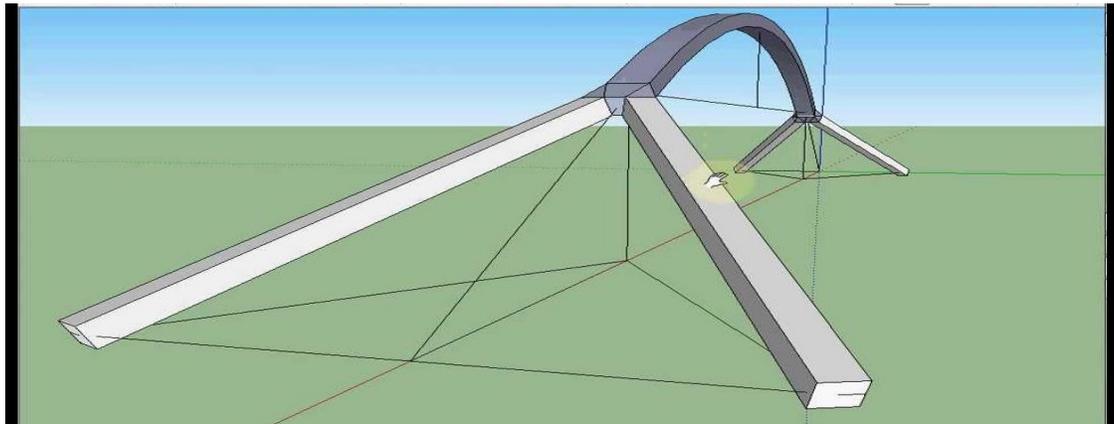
Puente de La Barqueta 6 de 6 Tornapuntas y Traviesa
